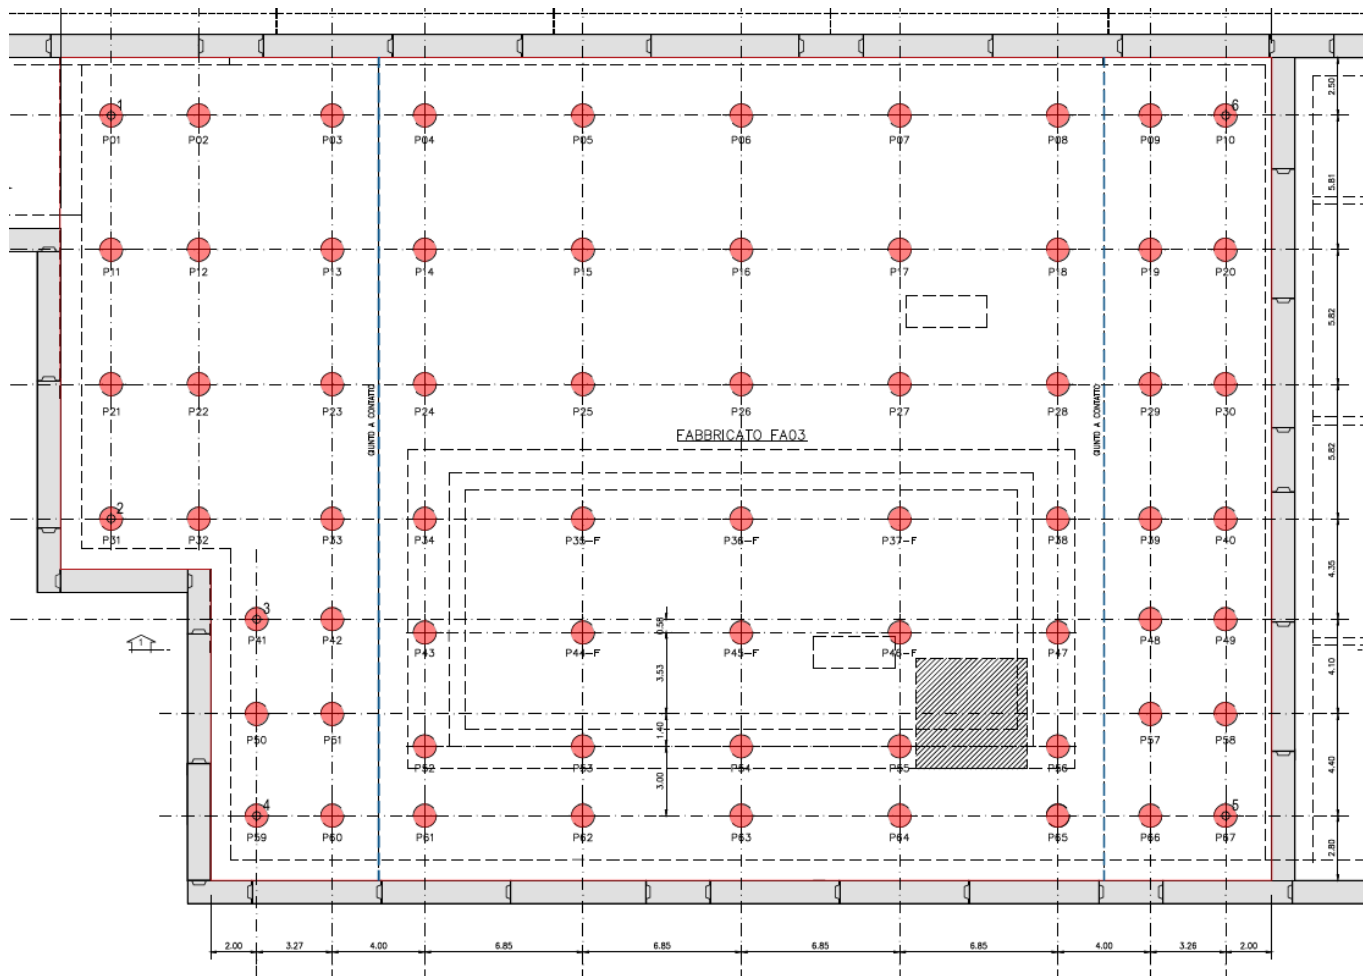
Planimetria pali di fondazione piazzale quota piano ferro
